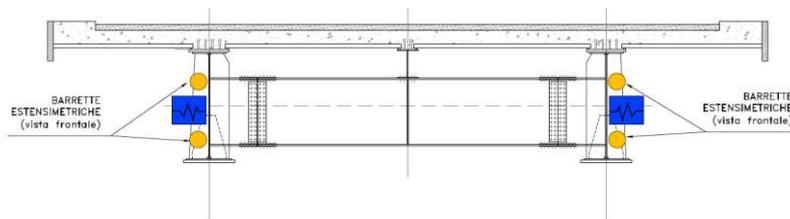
Sezioni tipo impalcato posizionamento strumentazioni ponti e viadotti
